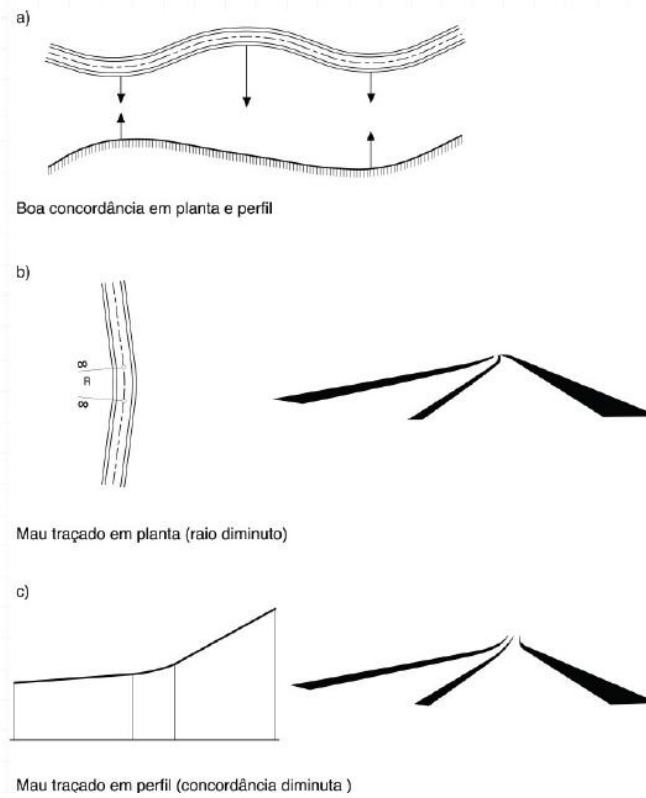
Coordenação do Traçado em Planta e Perfil 1 (Fonte: fig. 12A, [18] ou [19])
